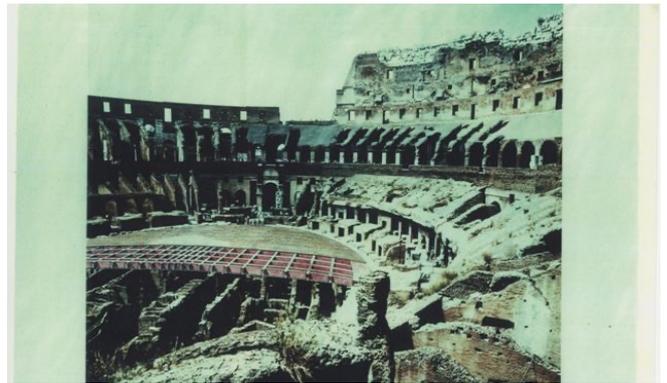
M. D'Olivo intervento di restauro del Colosseo. Pavimentazione
